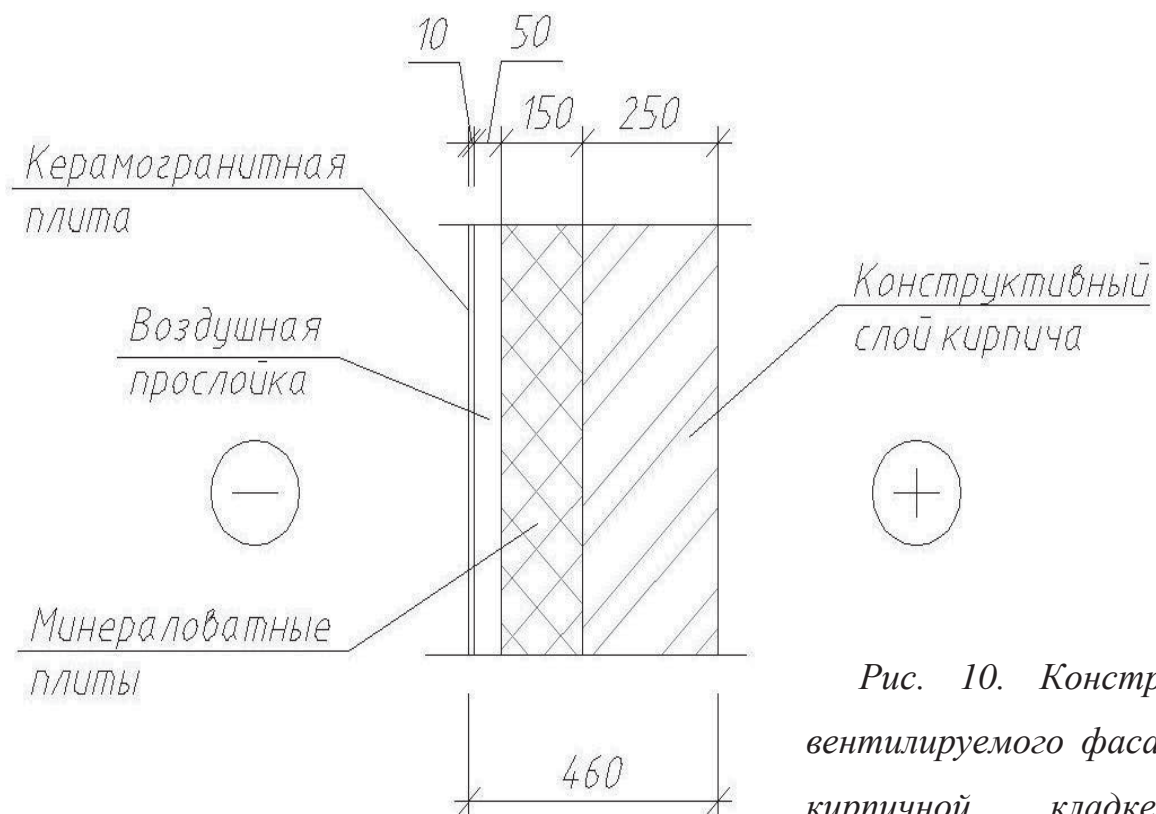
Конструкция вентилируемого фасада по кирпичной кладке с утеплением.
